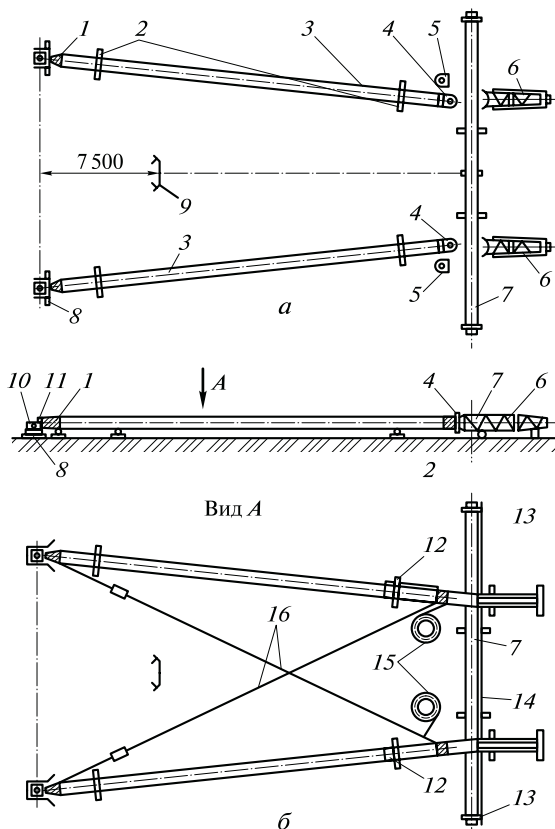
Сборка порталной железобетонной опоры на пикете:
